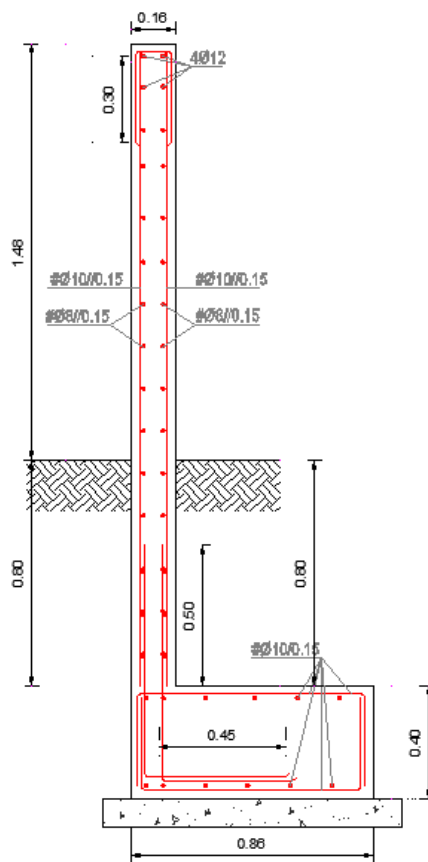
Pormenor dos muros exteriores (Fonte: Projeto de Estrutura)
